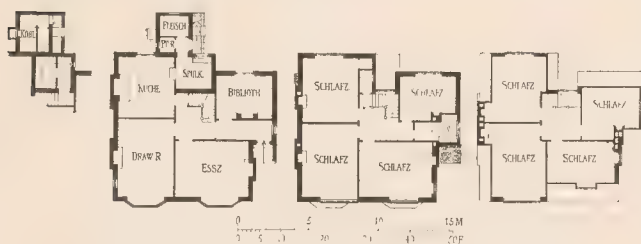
104. Grundrisse eines Einzelhauses der Kolonie Bedford Park bei London. Von R. Norman Shaw. Erbaut um 1880. 1:400.
